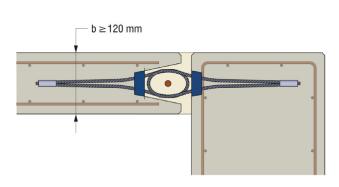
Wand – Wand – Eckverbindung - Regeldetail (planer Einbau)
